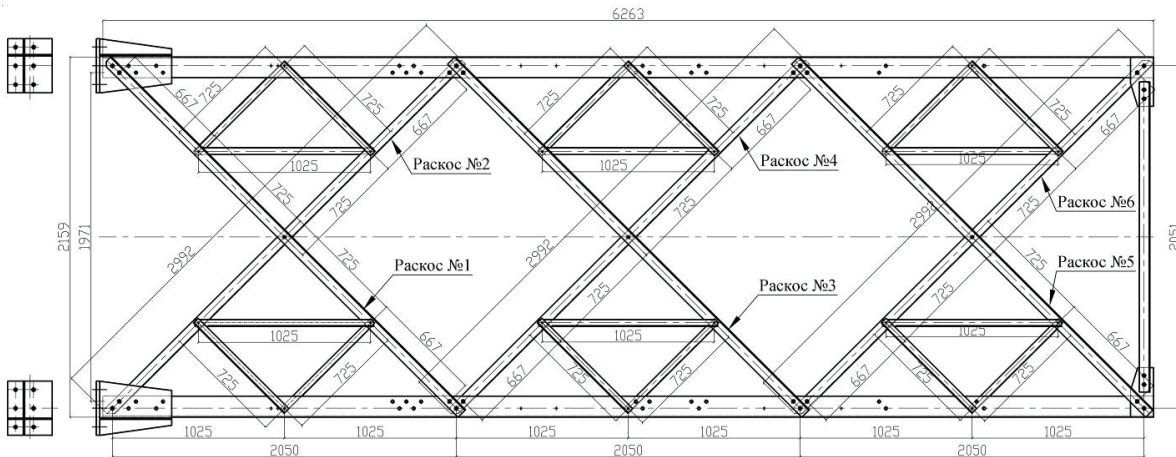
Монтажная схема испытуемой плоской фермы (раскосы из уголков  $L63 \times 5$ ).
